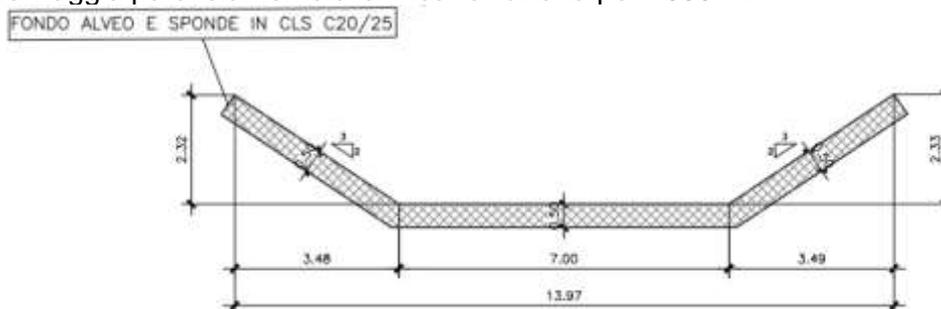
Sezione della sistemazione canale da km 13+921,37 a 15+121,78 (da PD).
